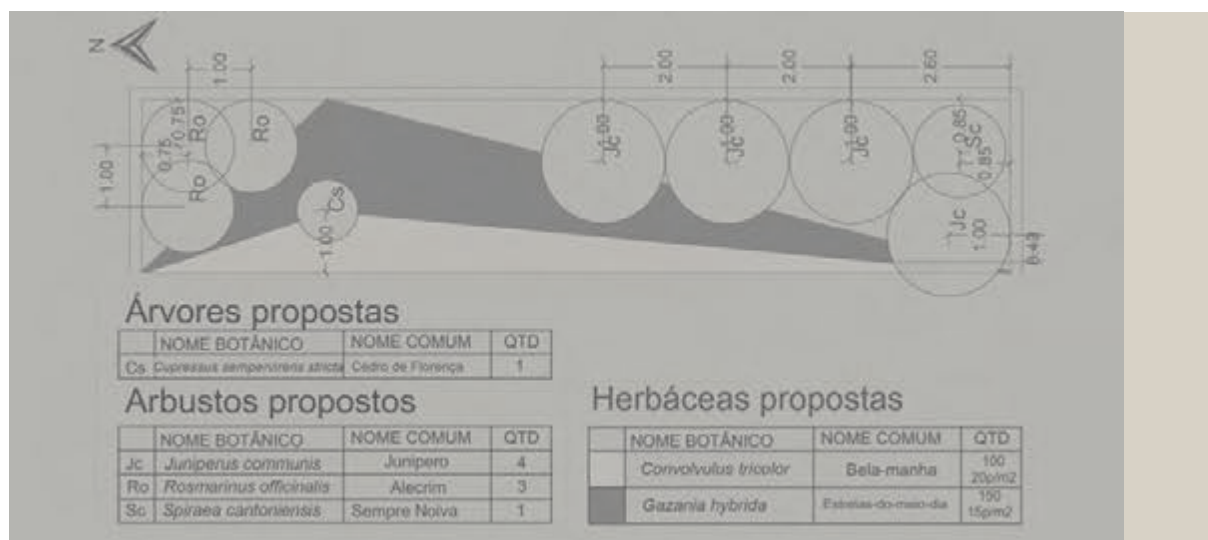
Plano de plantação. S/ escala. Fonte Autor
